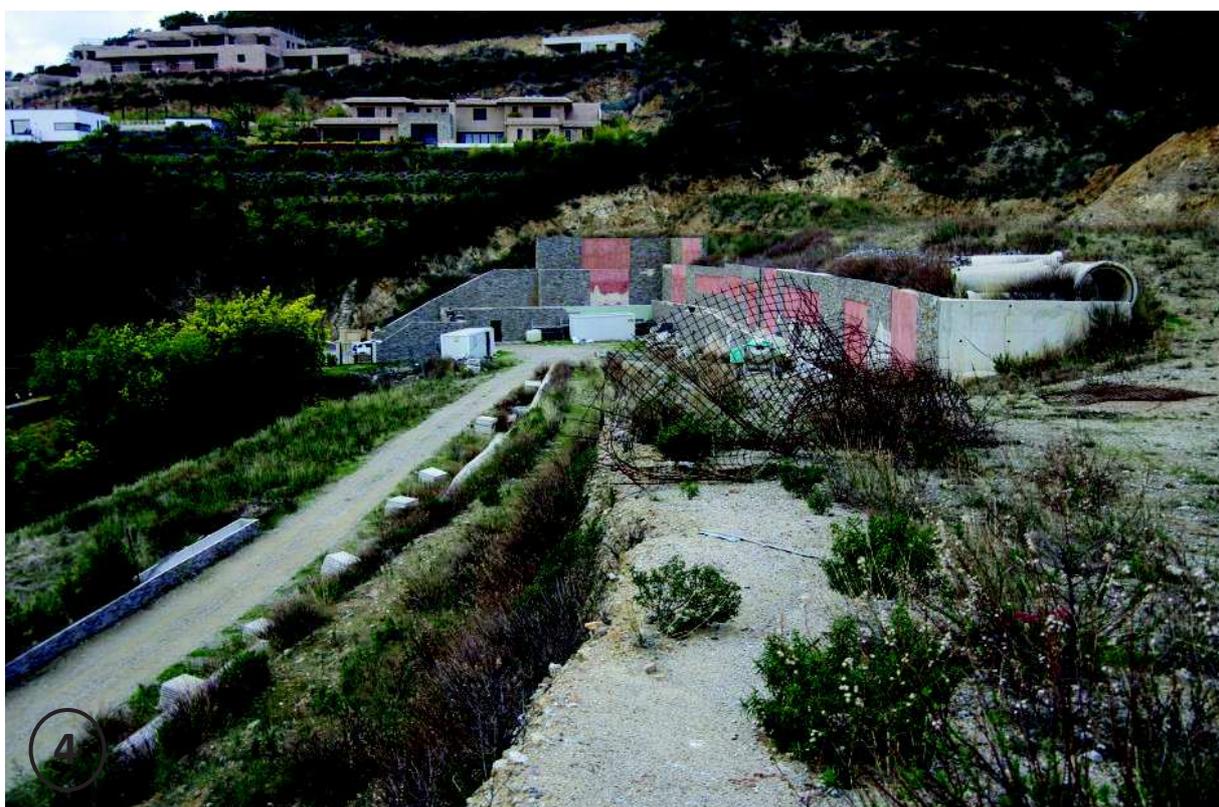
Murs de soutènement (Typicité – 19/02/2018)
